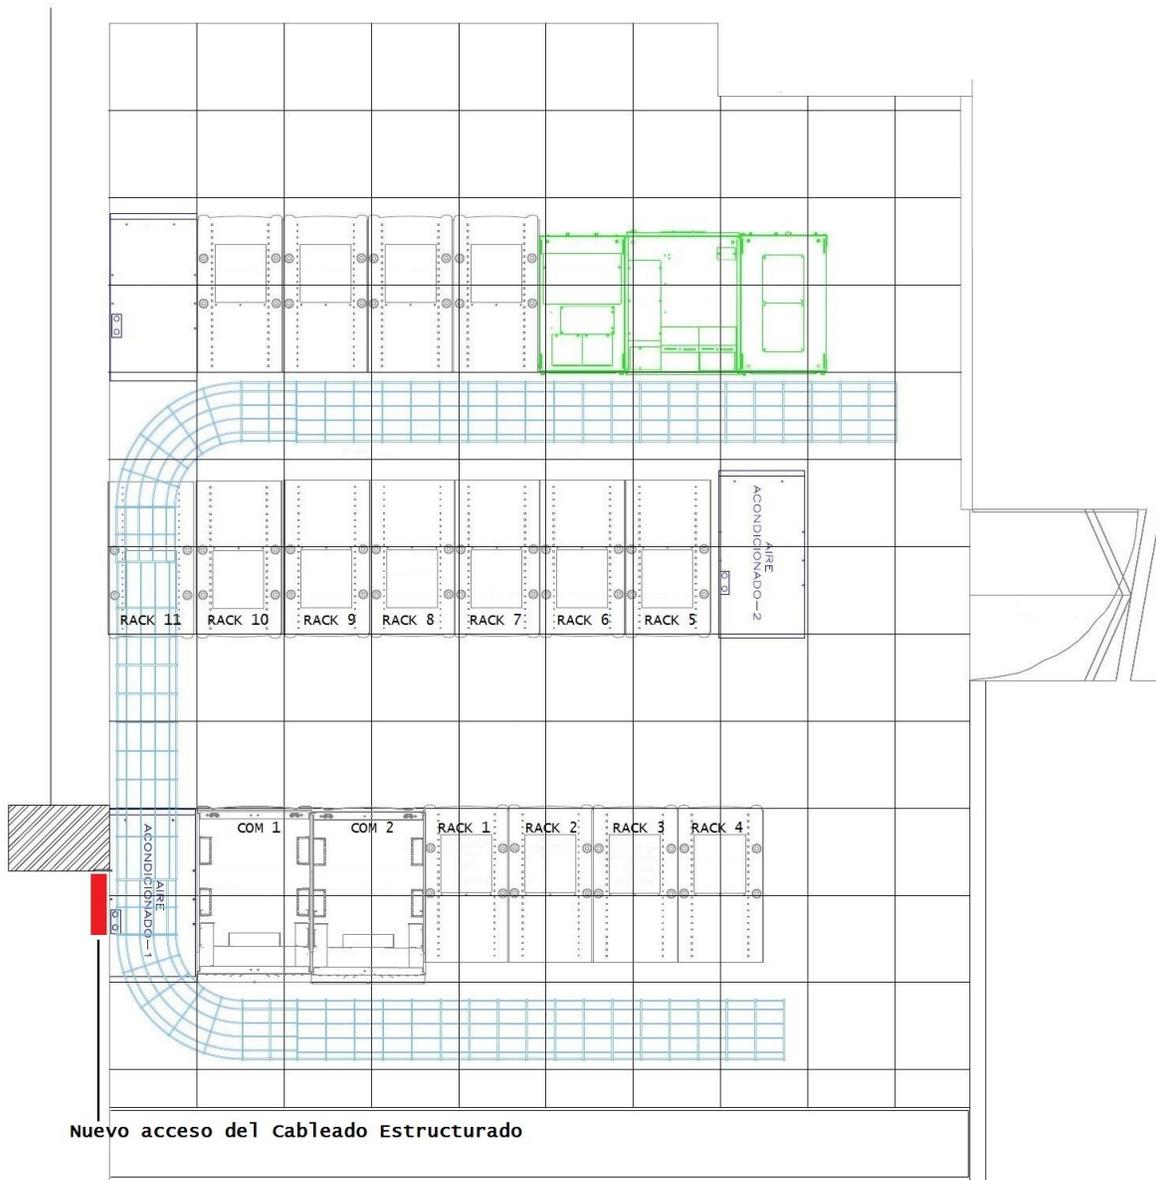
Plantado de *racks* y ruta de la escalerilla para el cableado estructurado.
